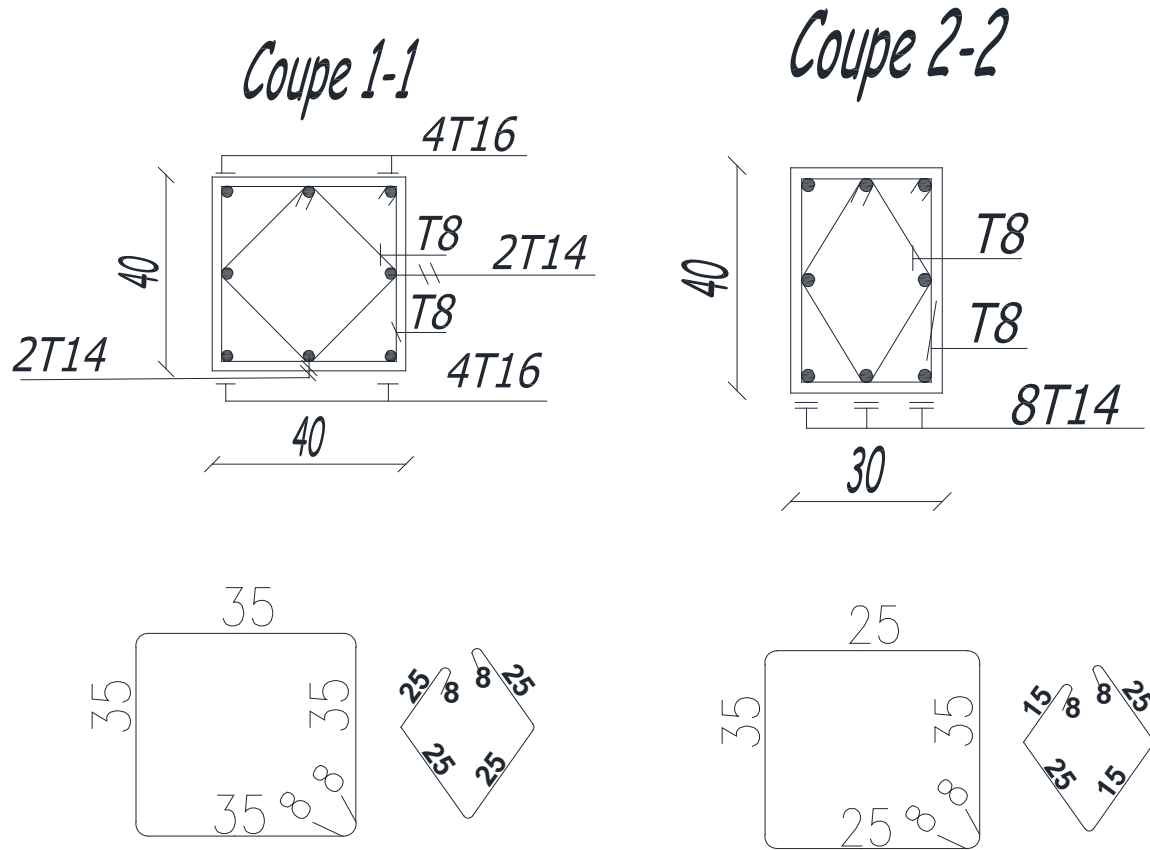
Schéma de ferrailage des poteaux (40X40) et poteaux (40X30).
